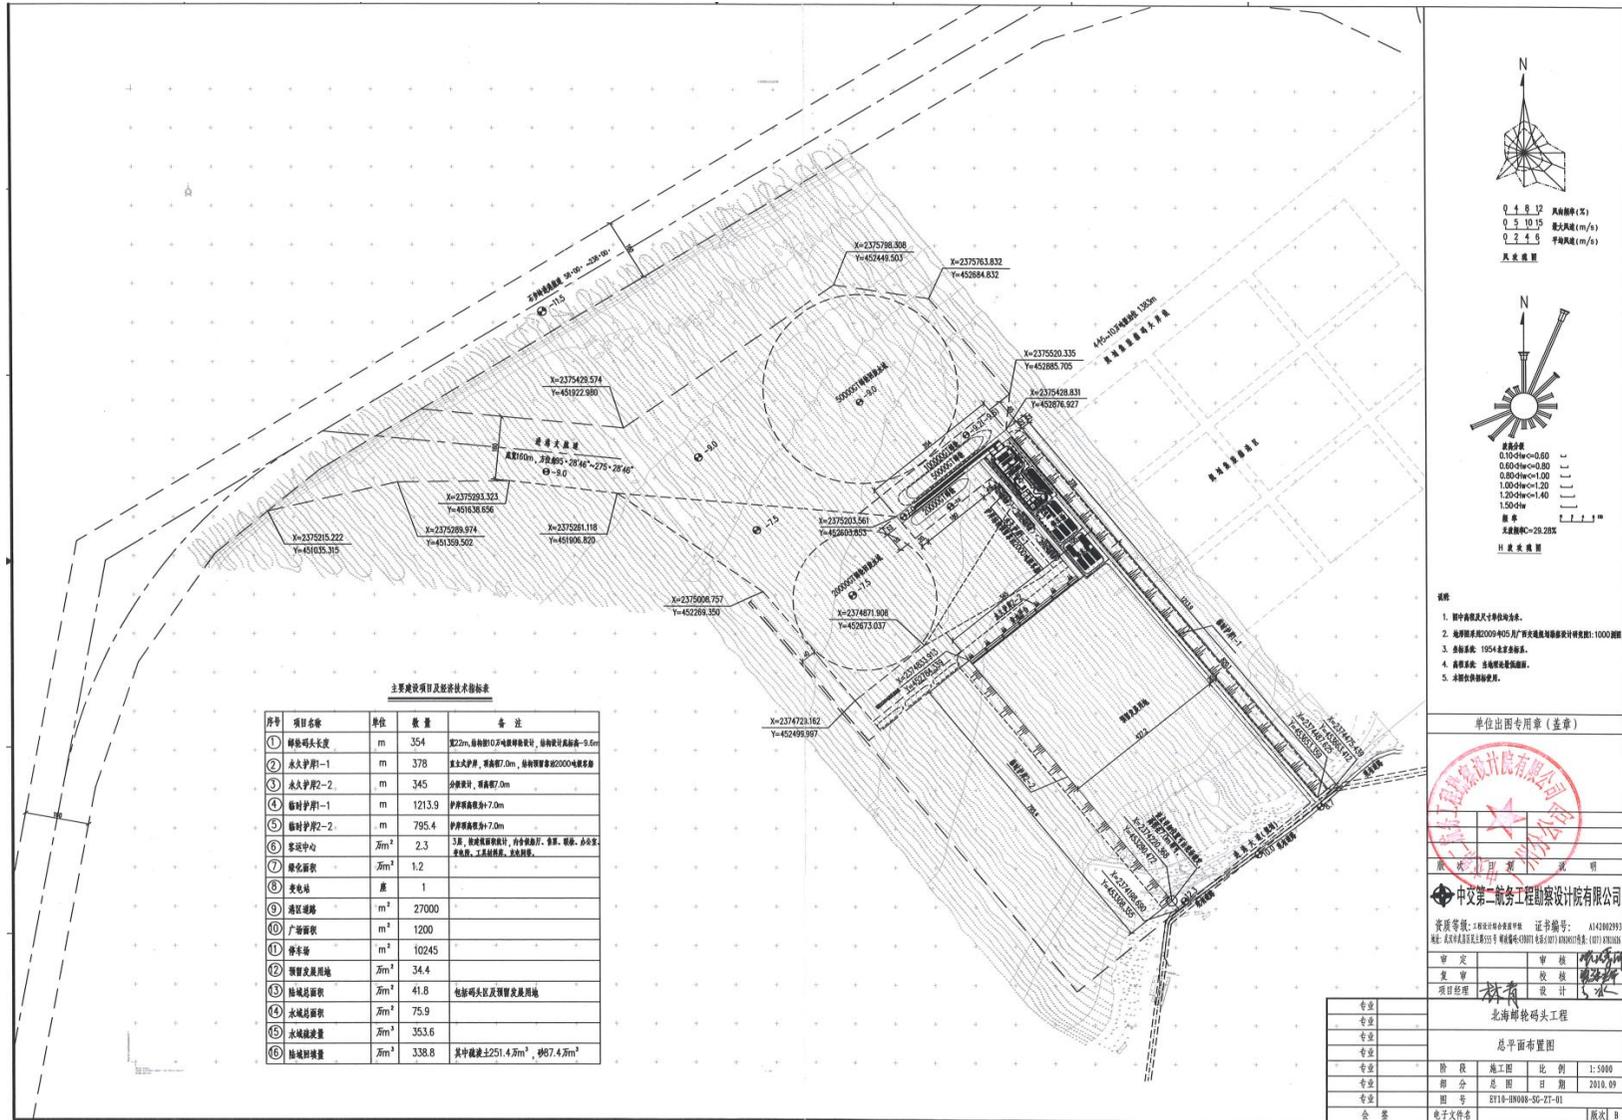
北海邮轮码头工程总平面布置设计图（截图自施工图设计，采用最低潮面）
